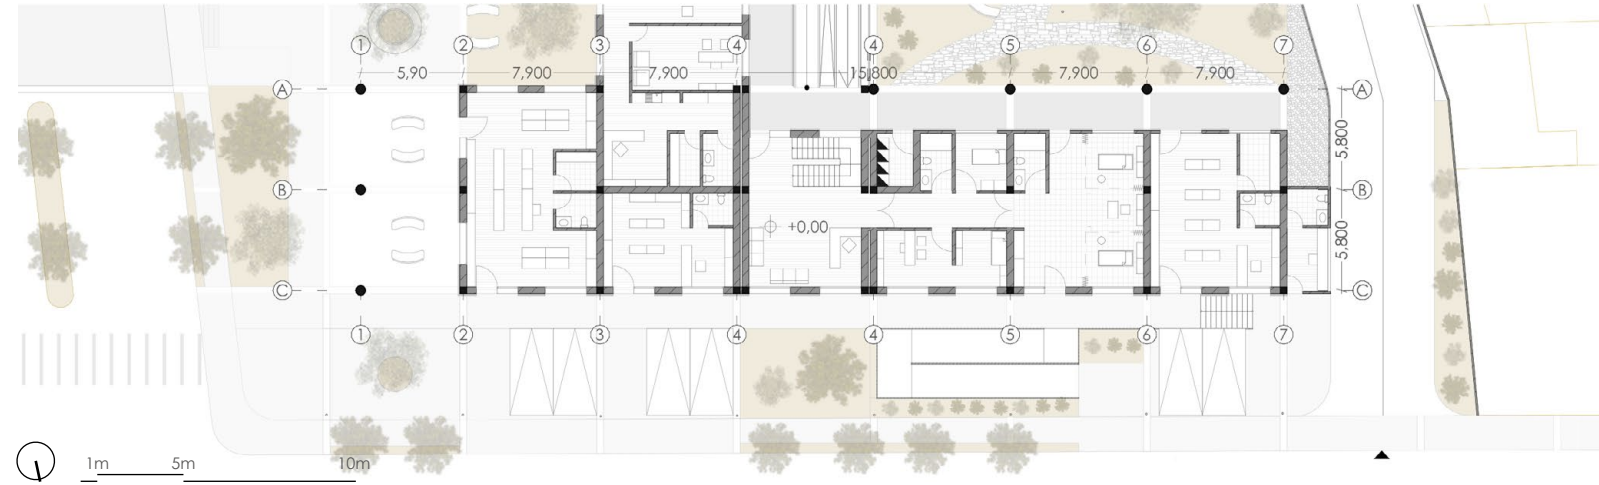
Planta Baja Edificio A. Fuente: Autoría propia.
